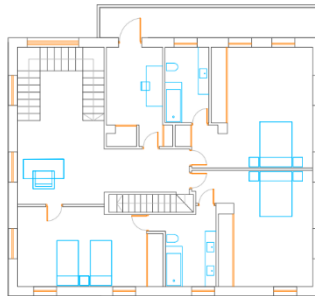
Plano de distribución Planta Primera. Fuente: CAD propio
